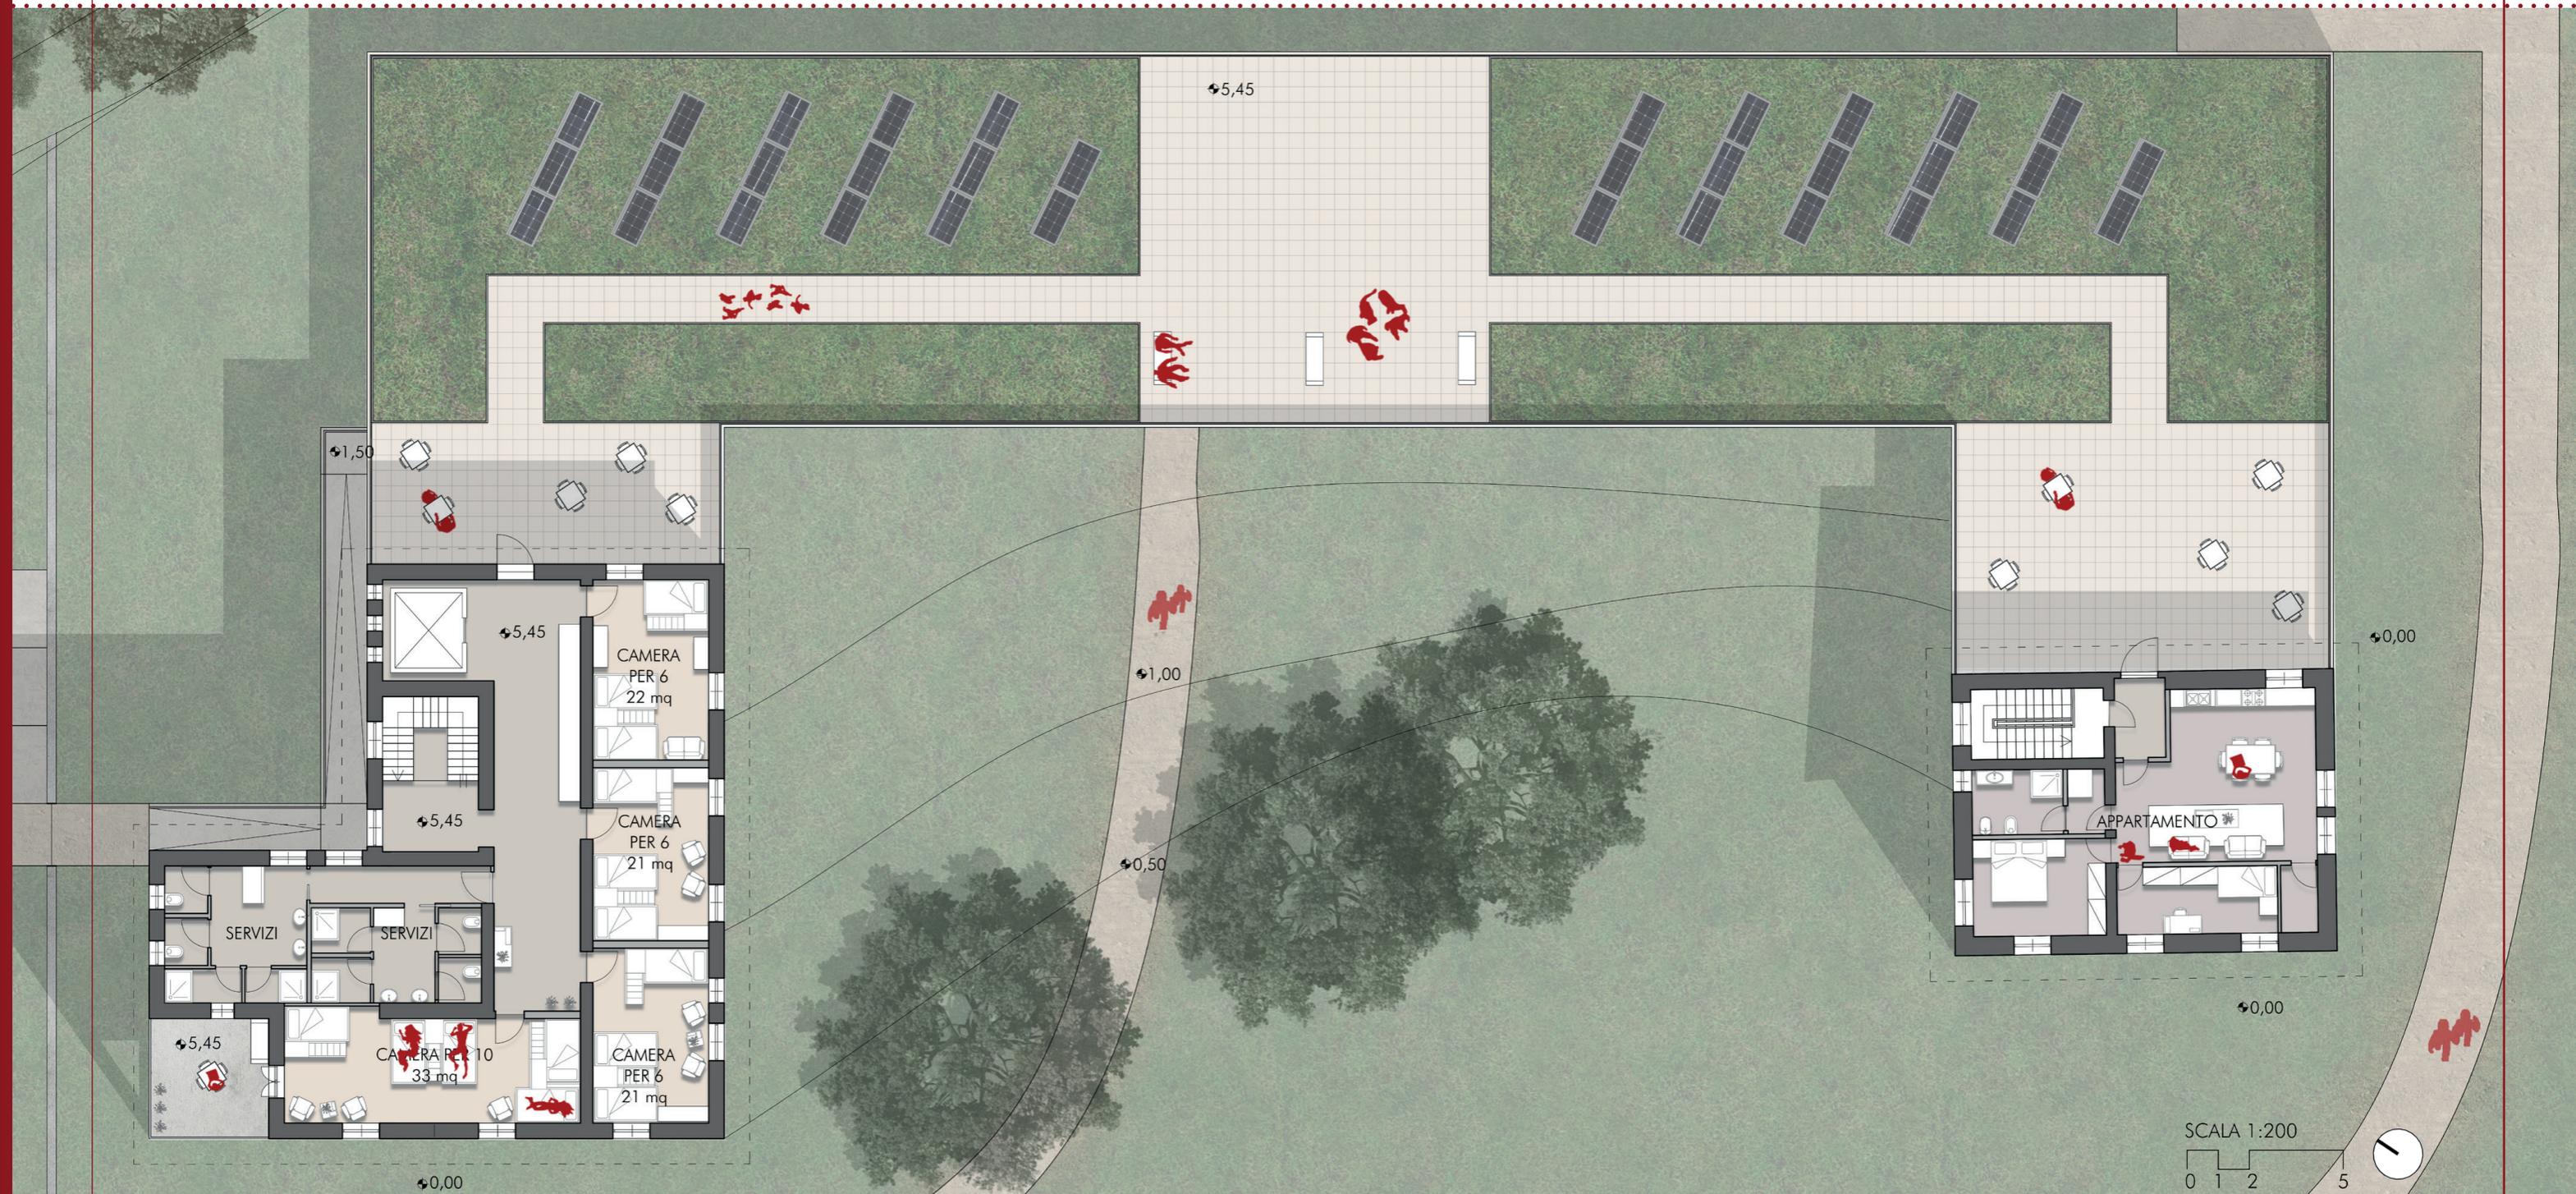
Pianta del piano primo dell'ostello e dei laboratori, elaborazione delle autrici
